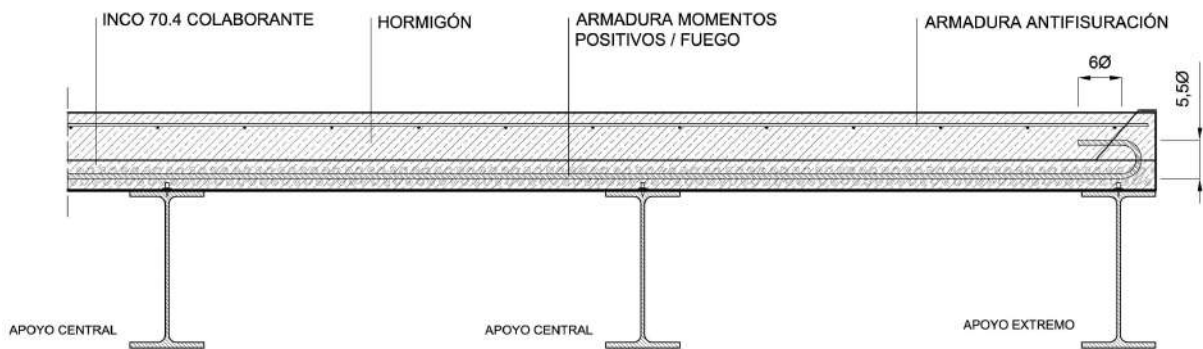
"Disposición de las armaduras de positivos/fuego sobre apoyos intermedios y extremo"
